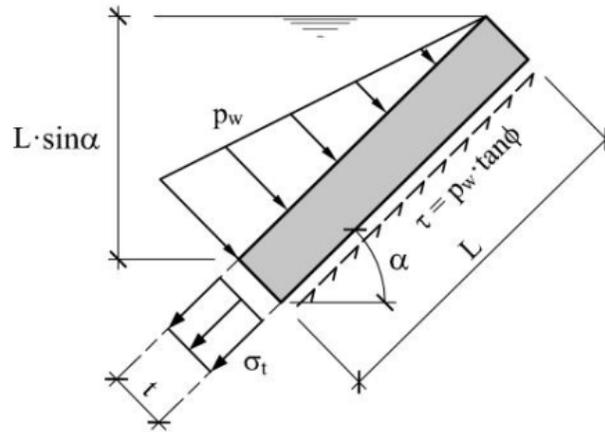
Esquema de esfuerzos en losa de hormigón. Fuente: Catalano et al. (2018).
